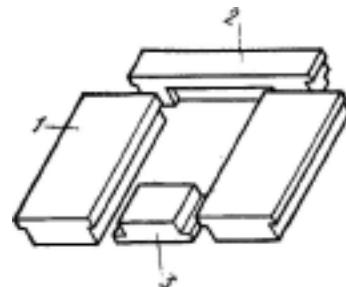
Крупноблочные наружные стены. Разрезка стен на блоки:
